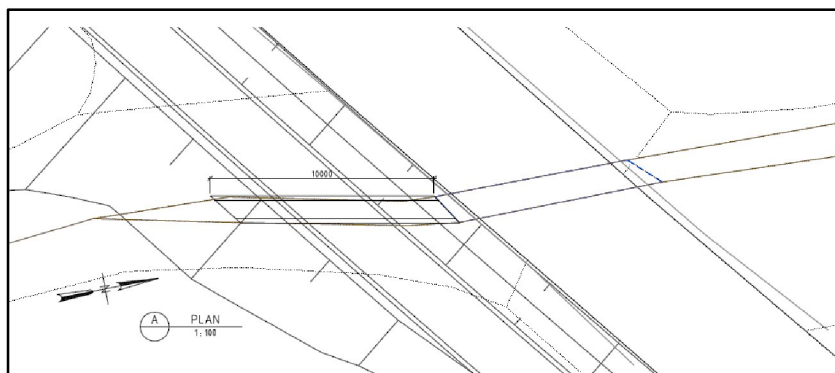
Tegning K02: Kulvert under rundkjøring, alt. 2 nordside med kulvert
